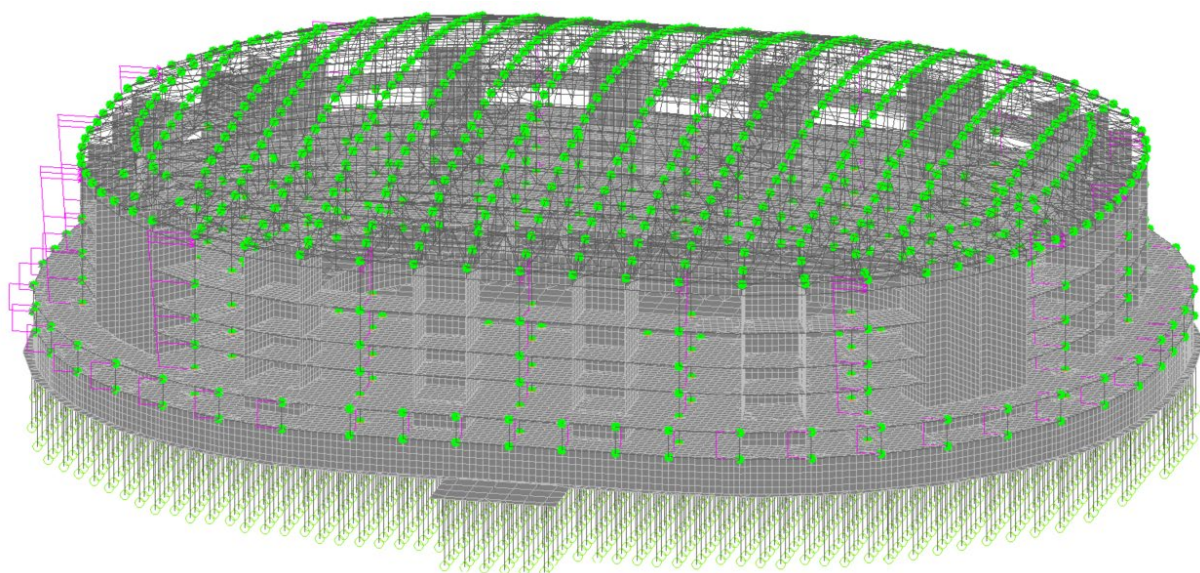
Схема приложения ветровой нагрузки на стены по оси X
